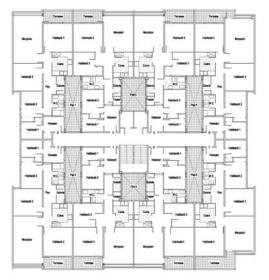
Esquema planta tipo del edifício situado en c/ Padilla 327 de Antoni de Moragas
